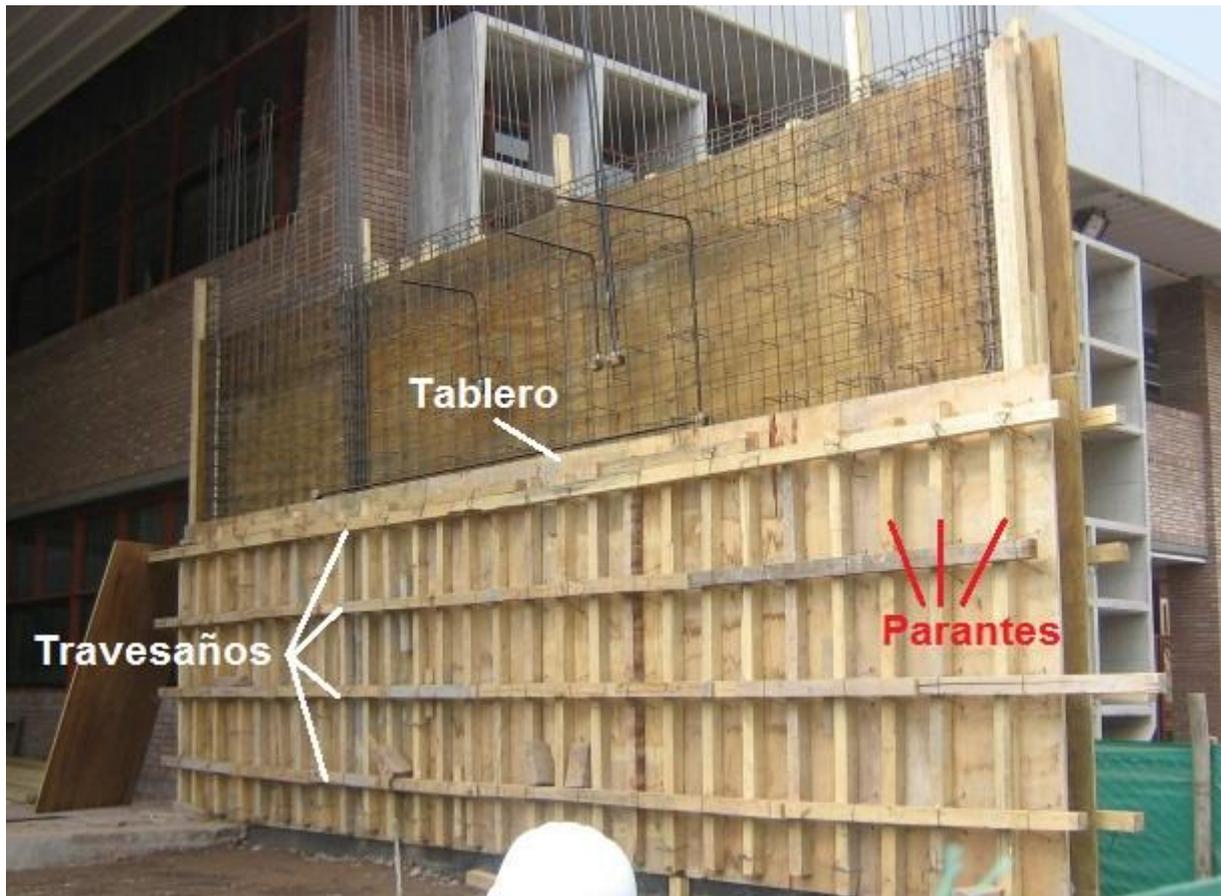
Proceso de encofrado de un tabique de H°A°, posteriormente se apuntala.
